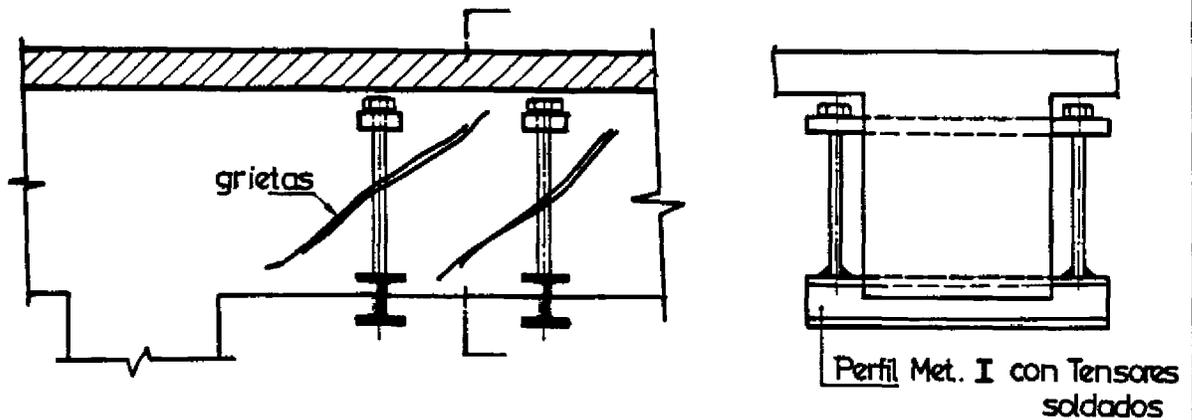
Caso V-6. REFUERZO EXTERIOR PARA ESFUERZO DE CORTE (perforación y tensores de acero)
